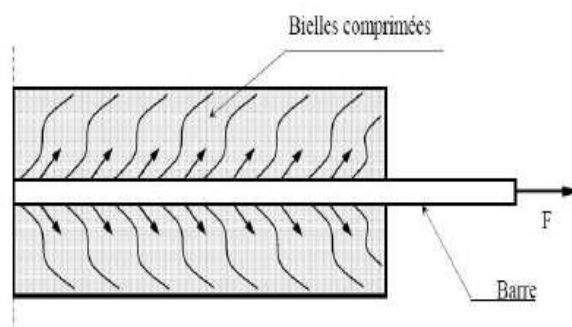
fissuration du béton sous l'effet de la tension de la barre [2]
